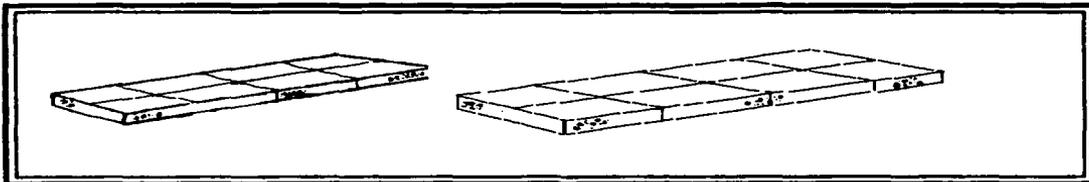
La primera muestra el agrietamiento en un piso de concreto sin juntas como resultado de los esfuerzos por cambios climáticos y por cargas aplicadas. La segunda muestra la separación adecuada entre juntas en pisos de concreto controla la ubicación y geometría de las grietas.
